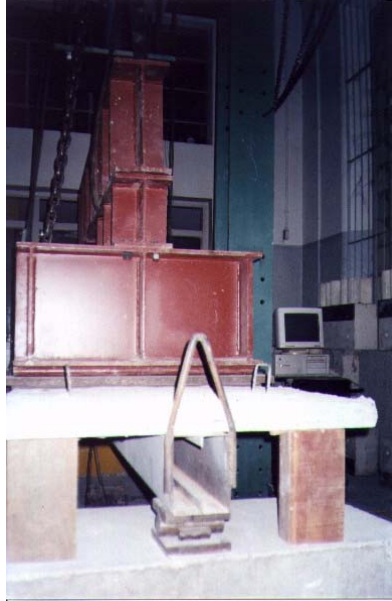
Detalhe do sistema ensaio para viga mista “Caixa” (modelos 5 e 6).
